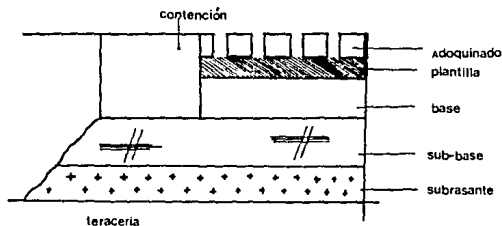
SECCION TRANSVERSAL TIPICA DE UN PAVIMENTO DE ADOQUINES PARA TRANSITO PESADO.
